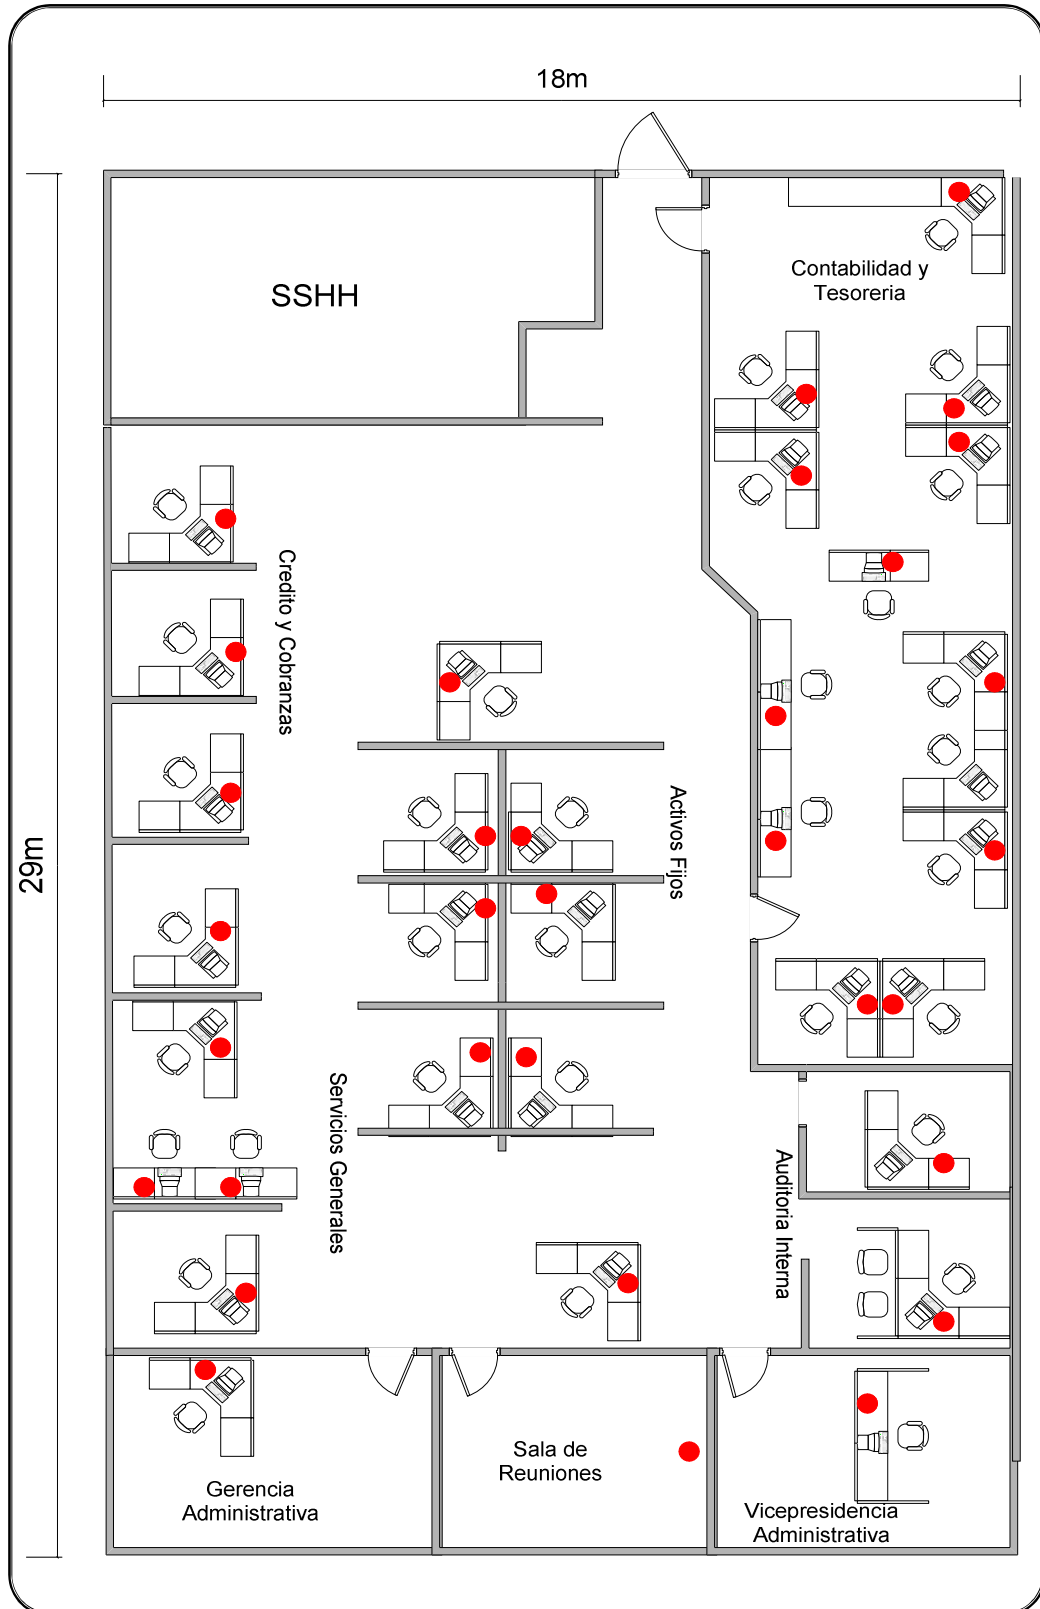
5 LAN Edificio Farmaenlace Planta Baja 2
